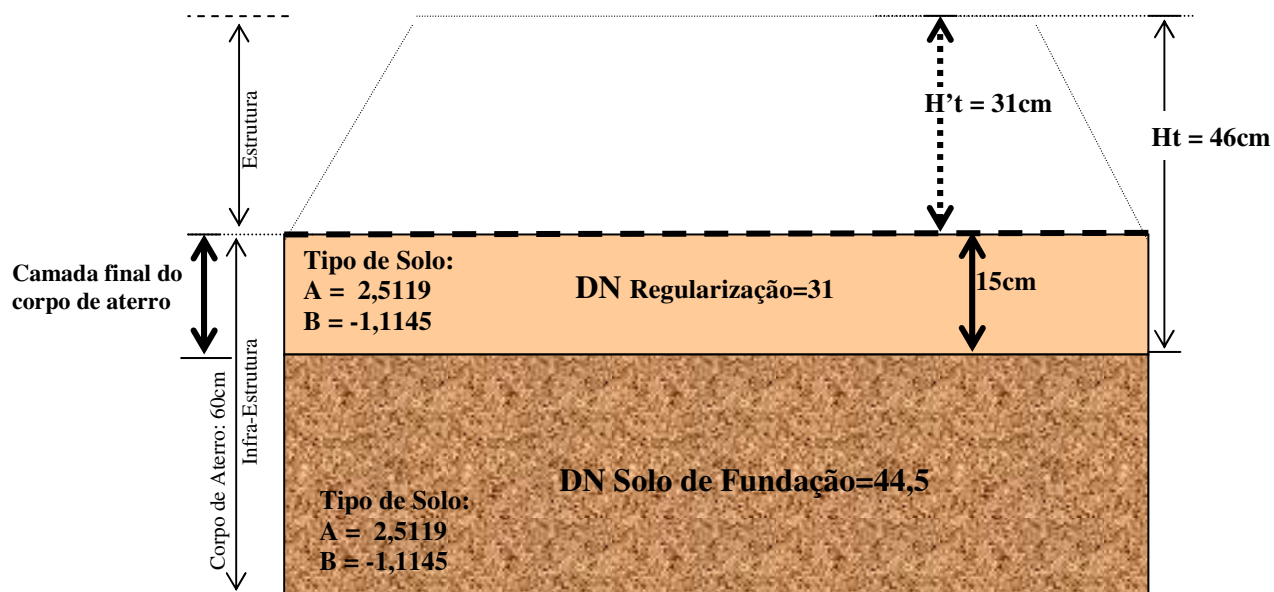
Esquema da estrutura do pavimento após compactação da camada final de aterro (PMSP/92).
